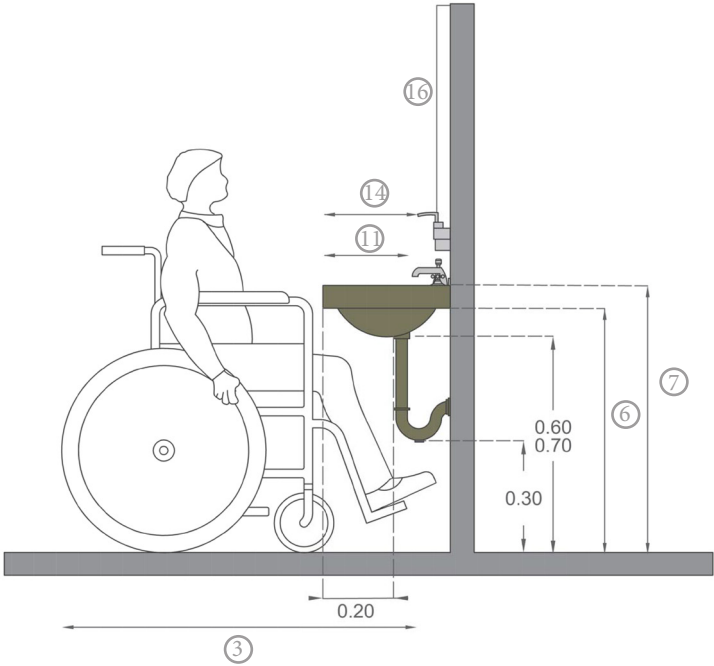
2 Altura y espacio libre inferior de lavabo - Alzado
